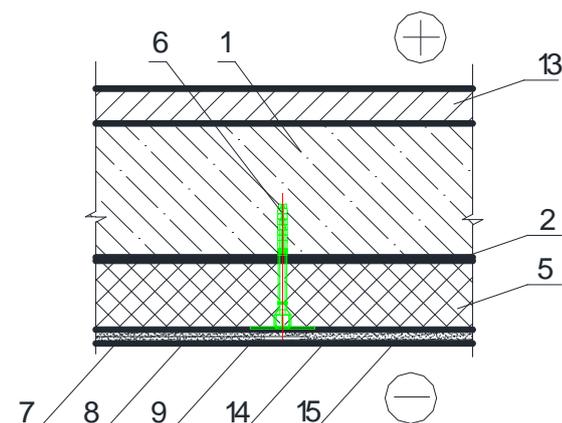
Розрахункова схема утепленого покриття: 1 - основа – залізобетонна плита перекриття - 220 мм; 2 - адгезійна ґрунтовка - ґрунтувальна суміш Ceresit СТ 17 та клеювий шар для приклеювання плит утеплювача до основи, а також для вирівнювання поверхні основи - суха цементно- піщана суміш Ceresit СТ 190 - 10 мм; 5 - теплоізоляційний шар - мінеральна вата IZOVAT 135 – 200 мм; 6 - елементи кріплення теплоізоляційних матеріалів - полімерні дюбелі із сердечником з нержавіючої сталі; 8 - армуючий штукатурний шар - суха цементно- піщана суміш Ceresit СТ 190 - 3мм; 7 - армуюча сітка - Capatect-Gewebe 650/110 із нахльостом 100мм - 0,5мм; 9 - другий штукатурний шар - суха цементно- піщана суміш Ceresit СТ 190 - 5мм; 13 - бетонна підлога – 80 мм; 14 - декоративно-захисне покриття - Ceresit СТ 73 - 5мм; 15 - фарбування - 2 шари силіконовою фарбою Ceresit СТ 48 - 0,5мм.
